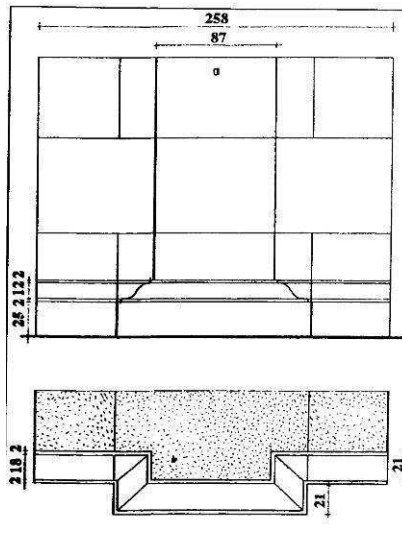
Elévation et plan d'une pile de façade (relevé J.-Cl. Golvin et M. Dridi).
